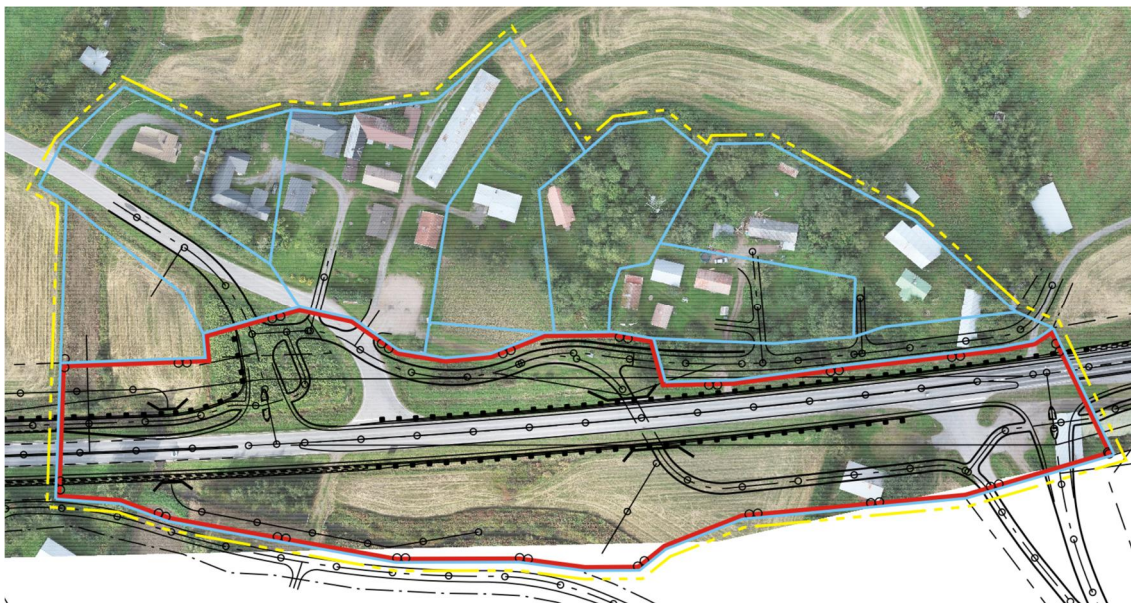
Utdrag ur planutkastet med vägplan i bakgrunden.
